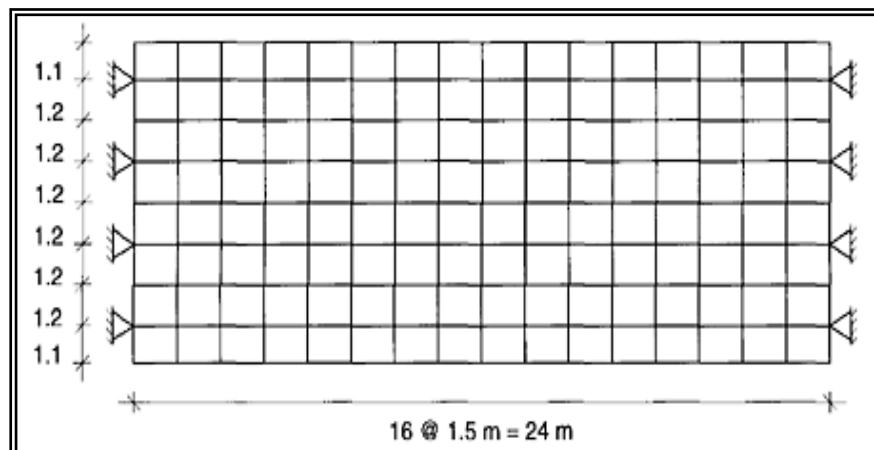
166 Grilla de tablero de puente¹⁸⁰.
